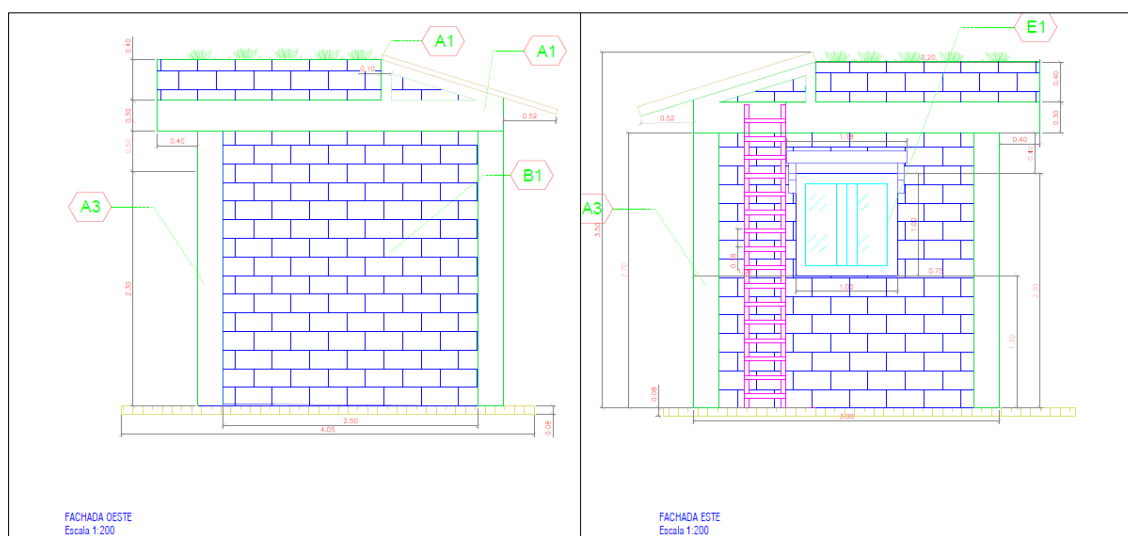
Planos arquitectónicos de las unidades. Fachada OESTE y fachada ESTE
